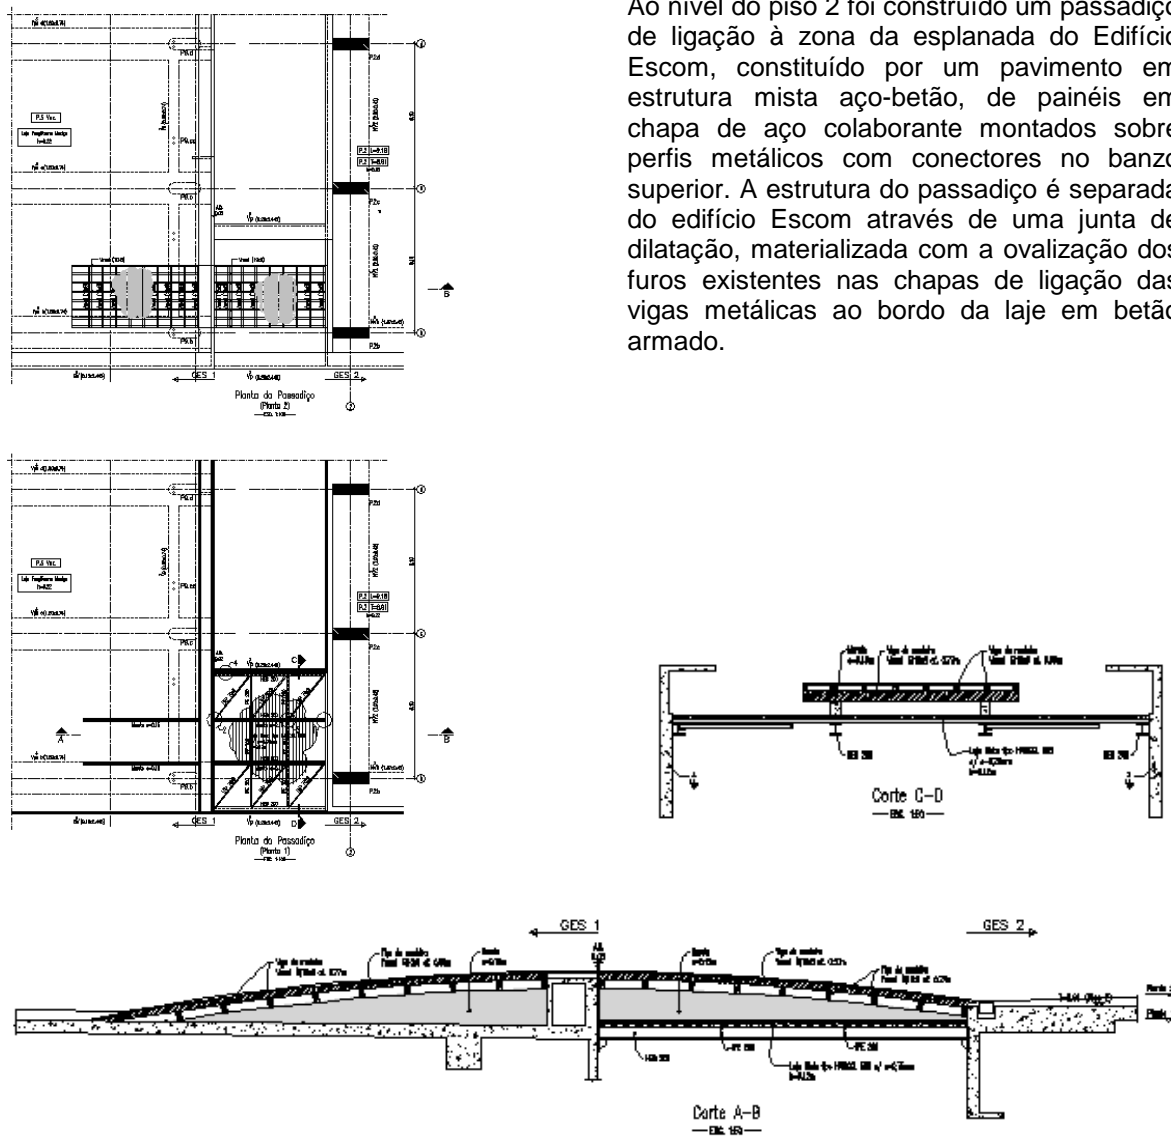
Planta e cortes do Passadiço de ligação entre os dois edifícios
